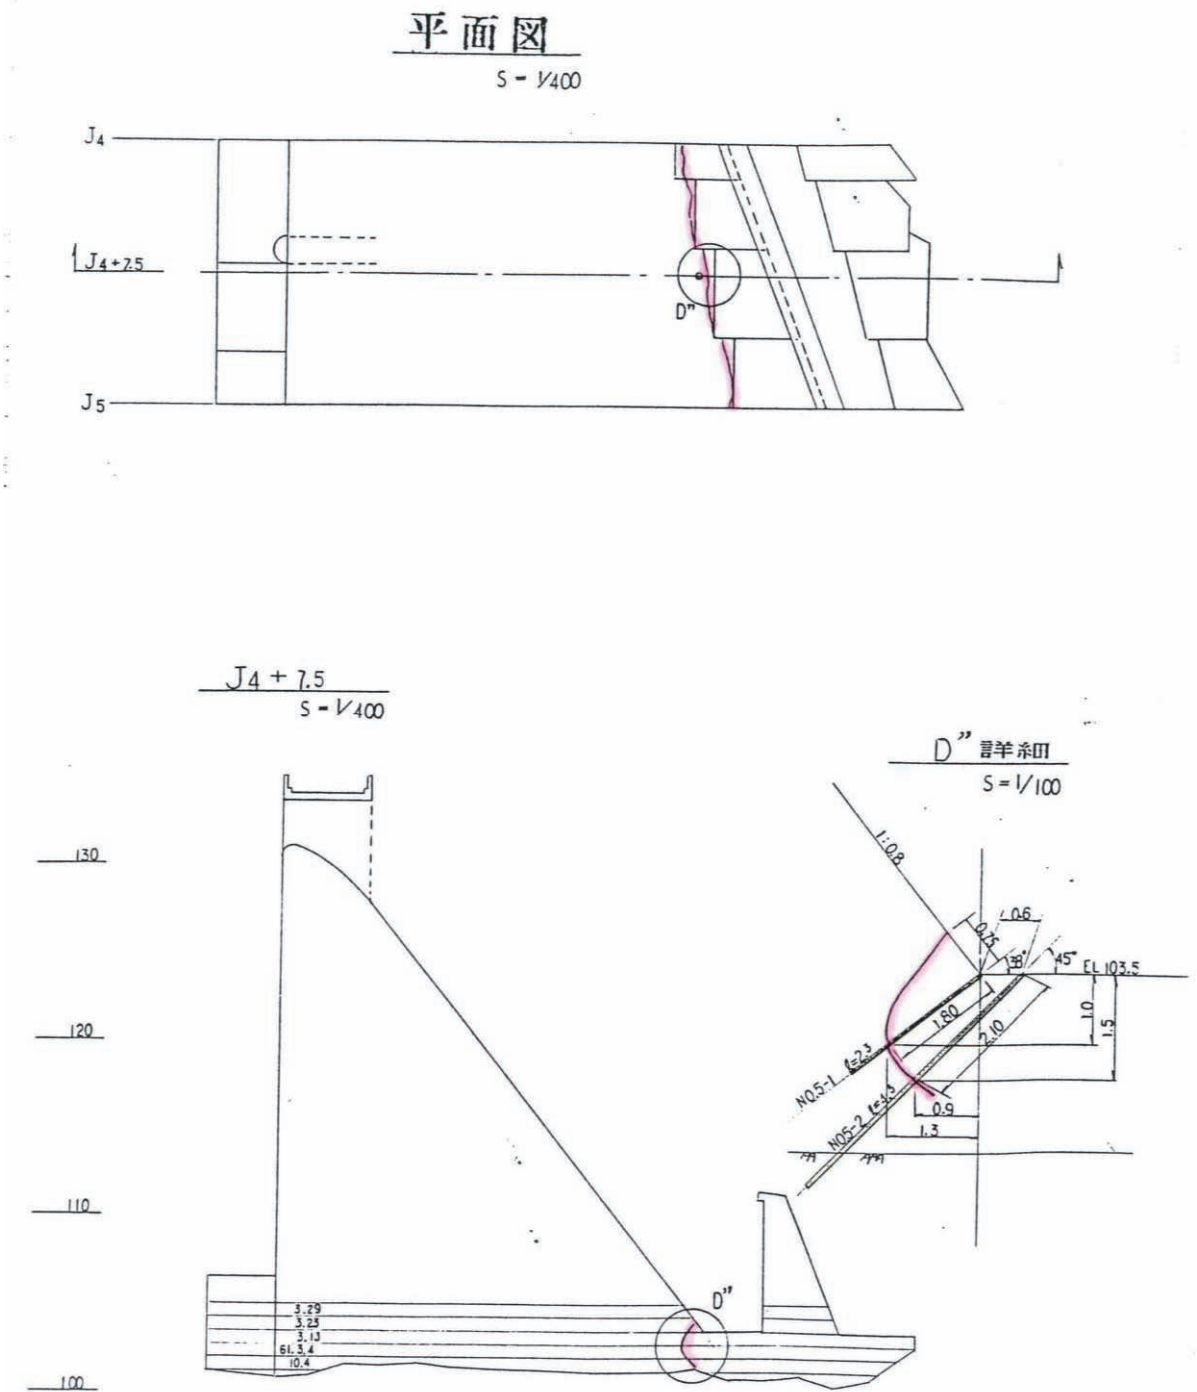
5BL ひび割れ追跡ボーリング位置図
